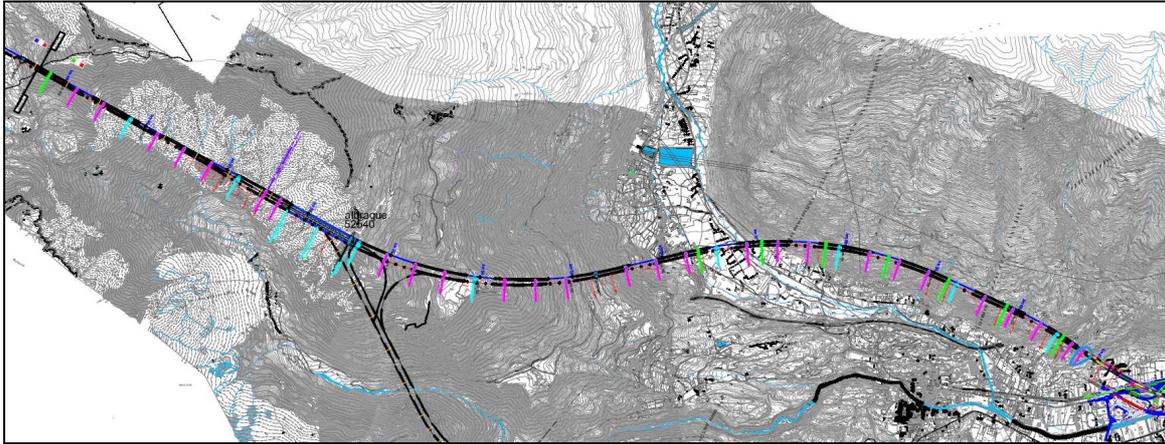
Planimetria del Tunnel di Base nella tratta lato Italia
